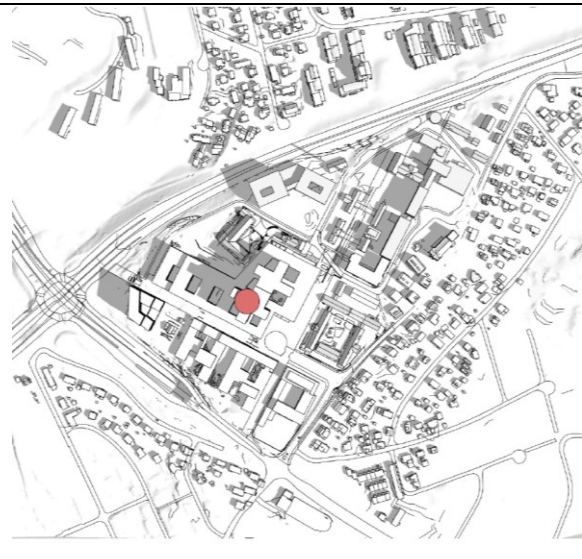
Planforslaget 21.3.2019 kl. 18.00.
